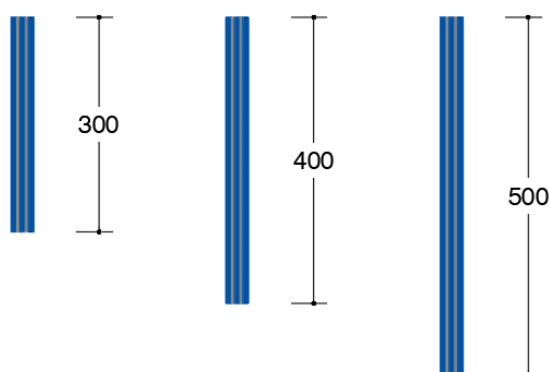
Secções das vigas em vidro laminado adotadas e espessuras de vidros variáveis (dimensões em mm)
